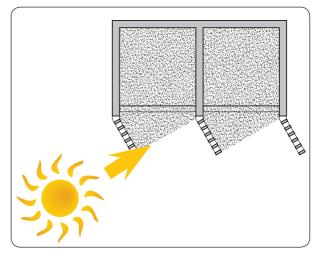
Grundriss Lamellen Quelle: In Anlehnung Köppen, E. & Stierli B. (2008), S. 6
